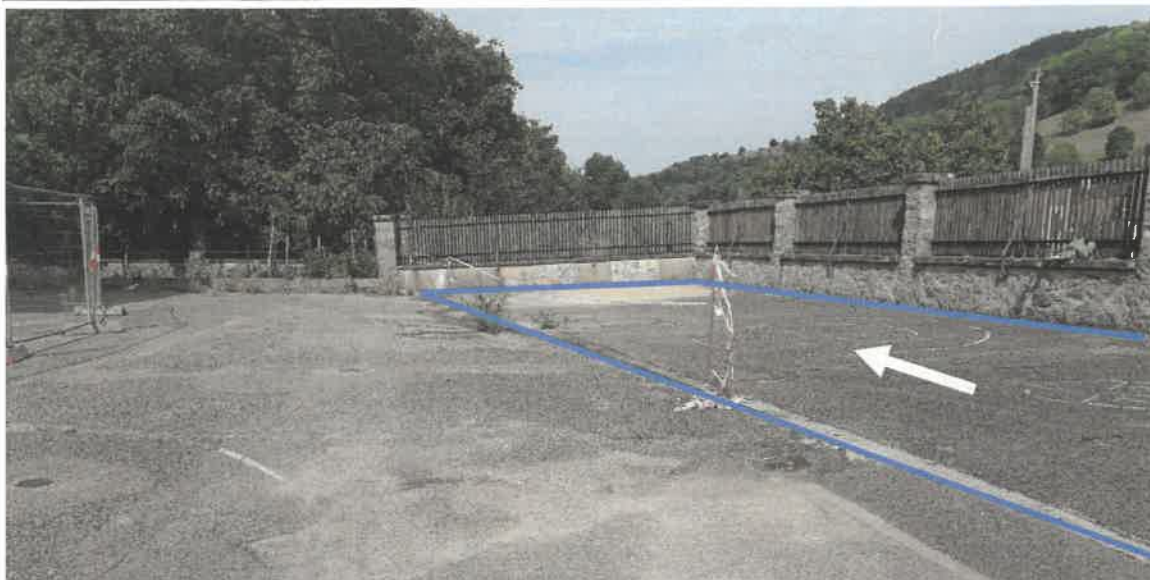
Photographie de la dalle béton qui recouvre le cours d'eau.
